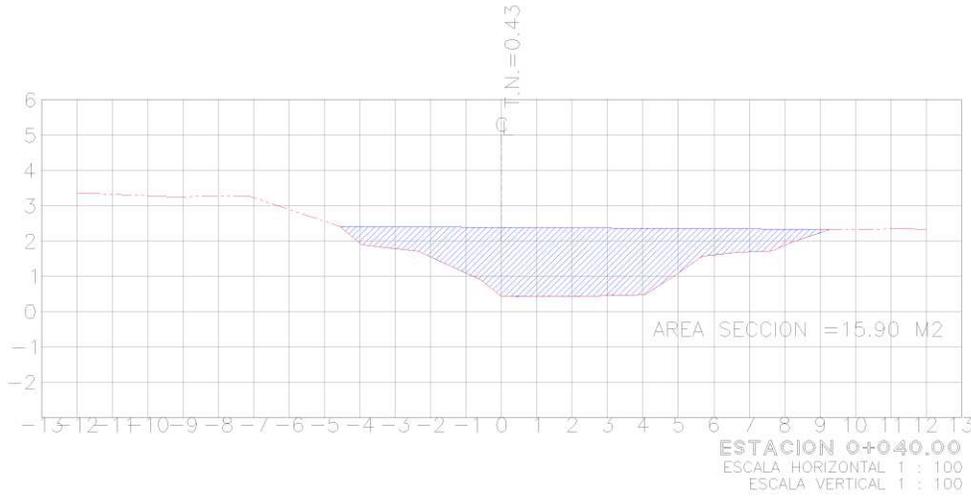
Sección de levantamiento topográfico de área de dren.
